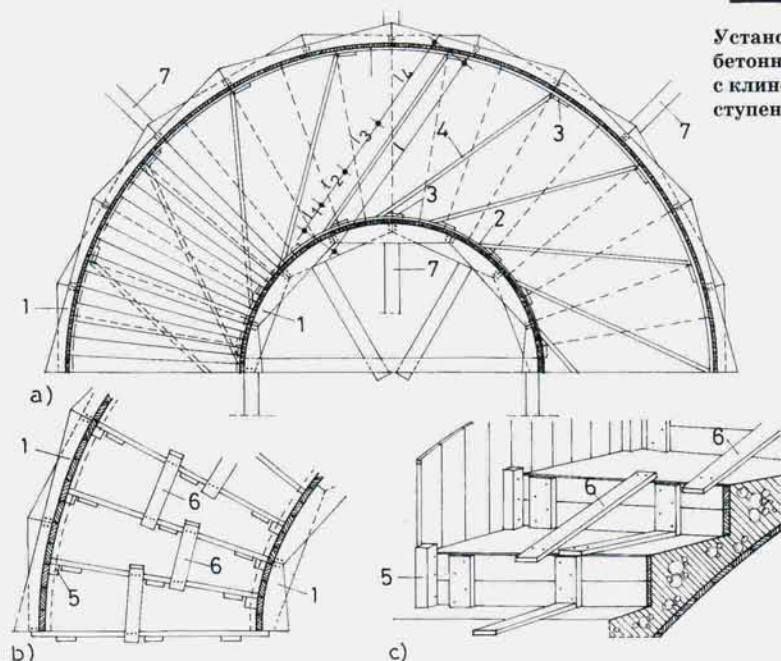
Фрагменты опалубки дугообразной железобетонной лестницы
